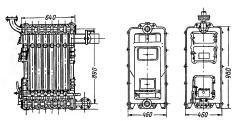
Габаритные размеры котла поверхностью нагрева 2,26 м<sup>2</sup>
